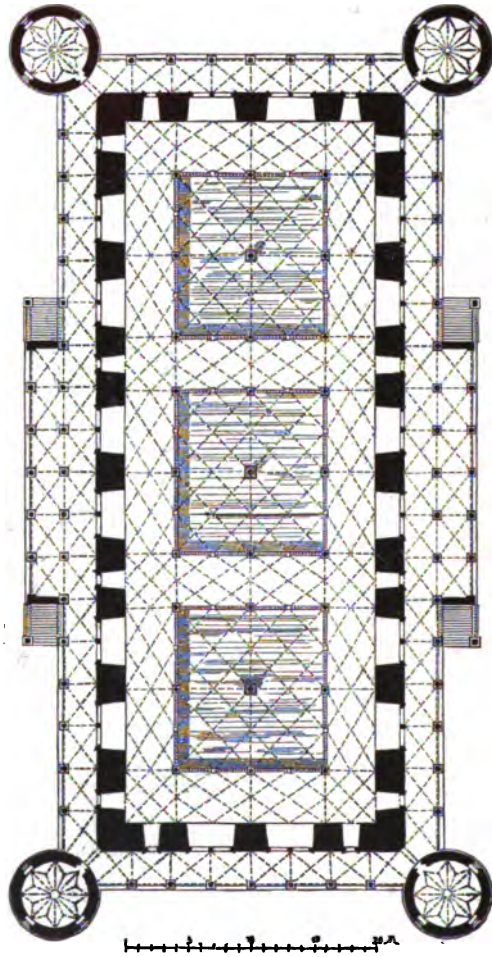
Lufthaus zu Stuttgart. Grundriss.
